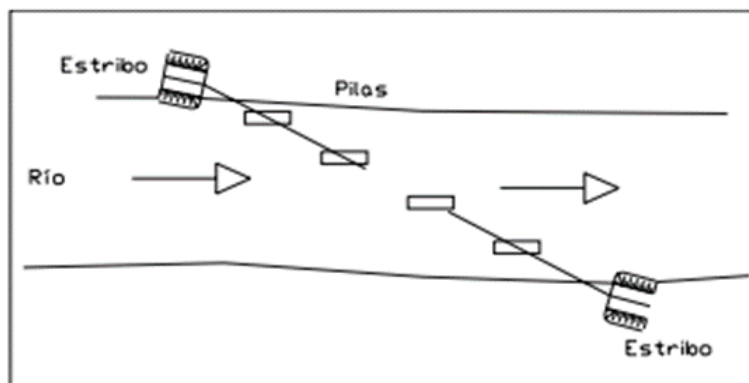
2 Alineación de pilas y estribos según la corriente.
